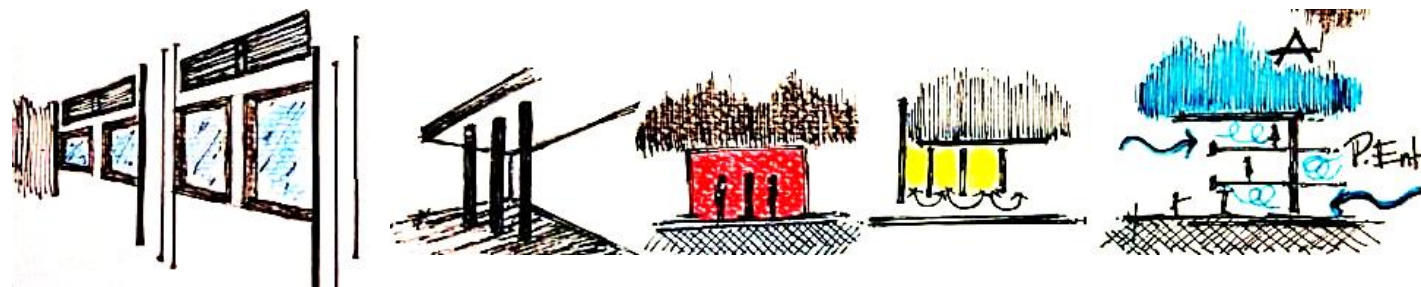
Dibujo a mano. Fuente. Propia Proyección elemento de fachada principal
